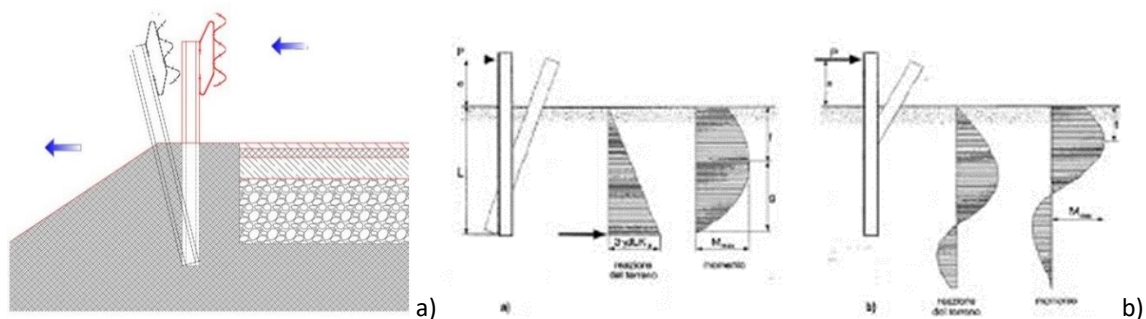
Ancoraggio barriera in terreno: a) schematizzazione b) tipi distribuzione sforzi montante-terreno
